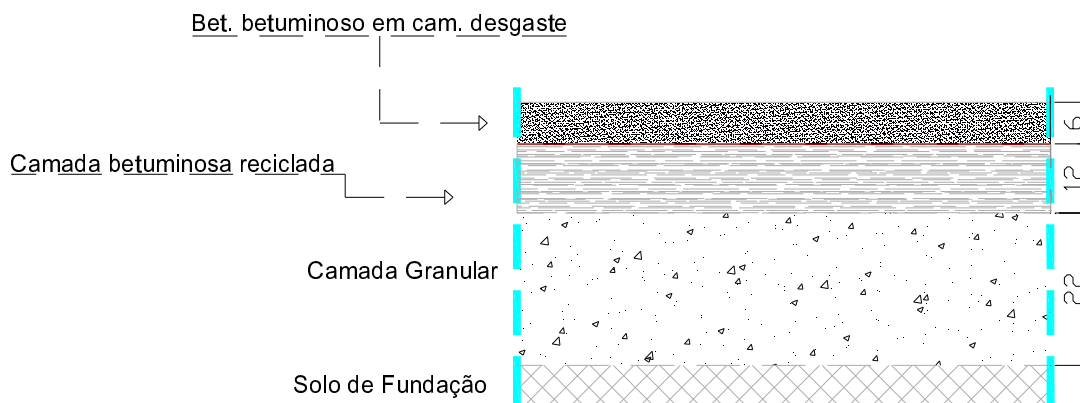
Estrutura do pavimento da Rua Associação Artística Vimaranesense para a alternativa de reciclagem *in situ* com espuma de betume
